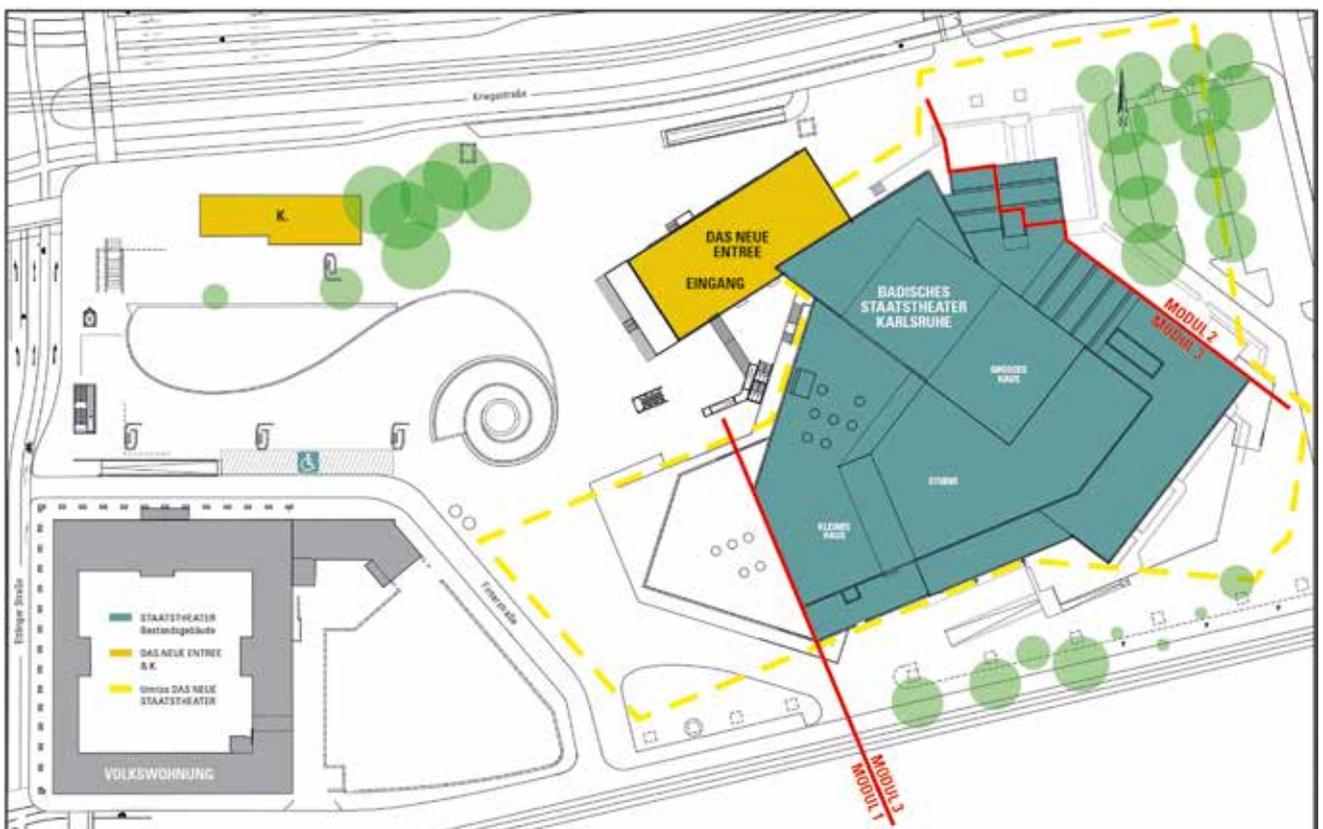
Bestandsgebäude und neuer Grundriss
